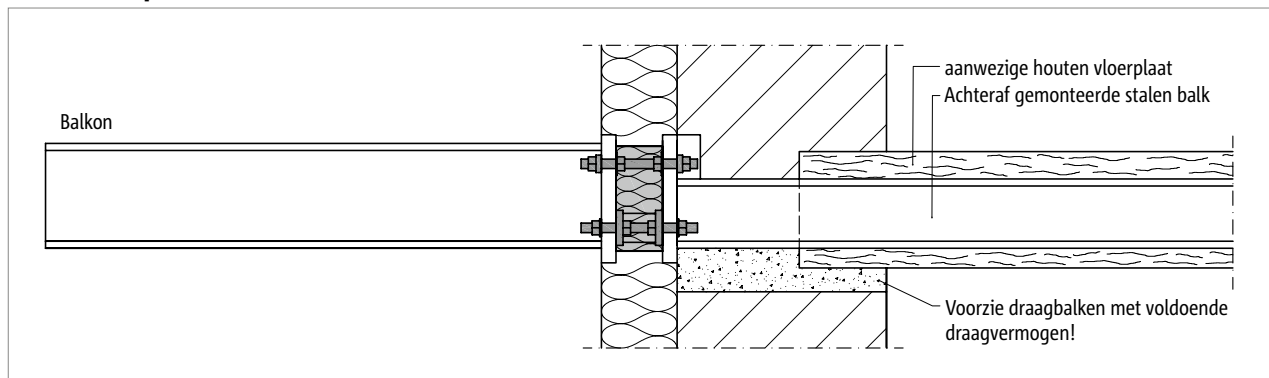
Schöck Isokorb® RT type K, Schöck Isokorb® T type K: Vrij uitkragend balkon met directe ondersteuning bij uitbreiding van bestaand balkon
